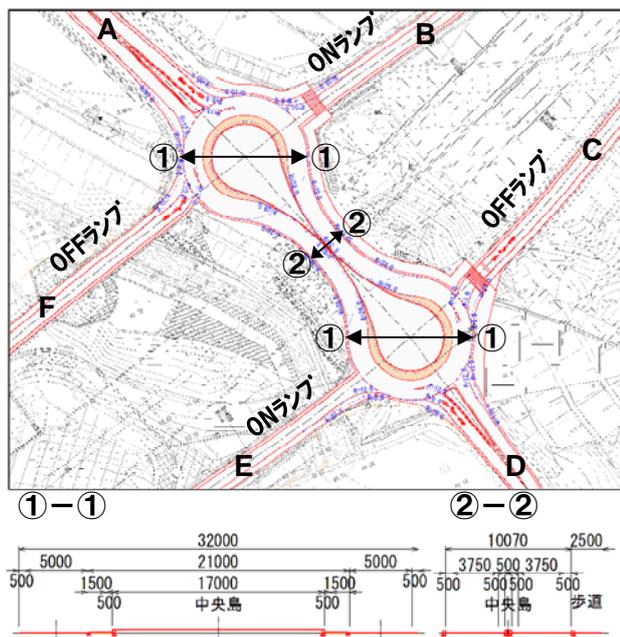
瓢箪型ラウンドアバウトの平面図と横断面
